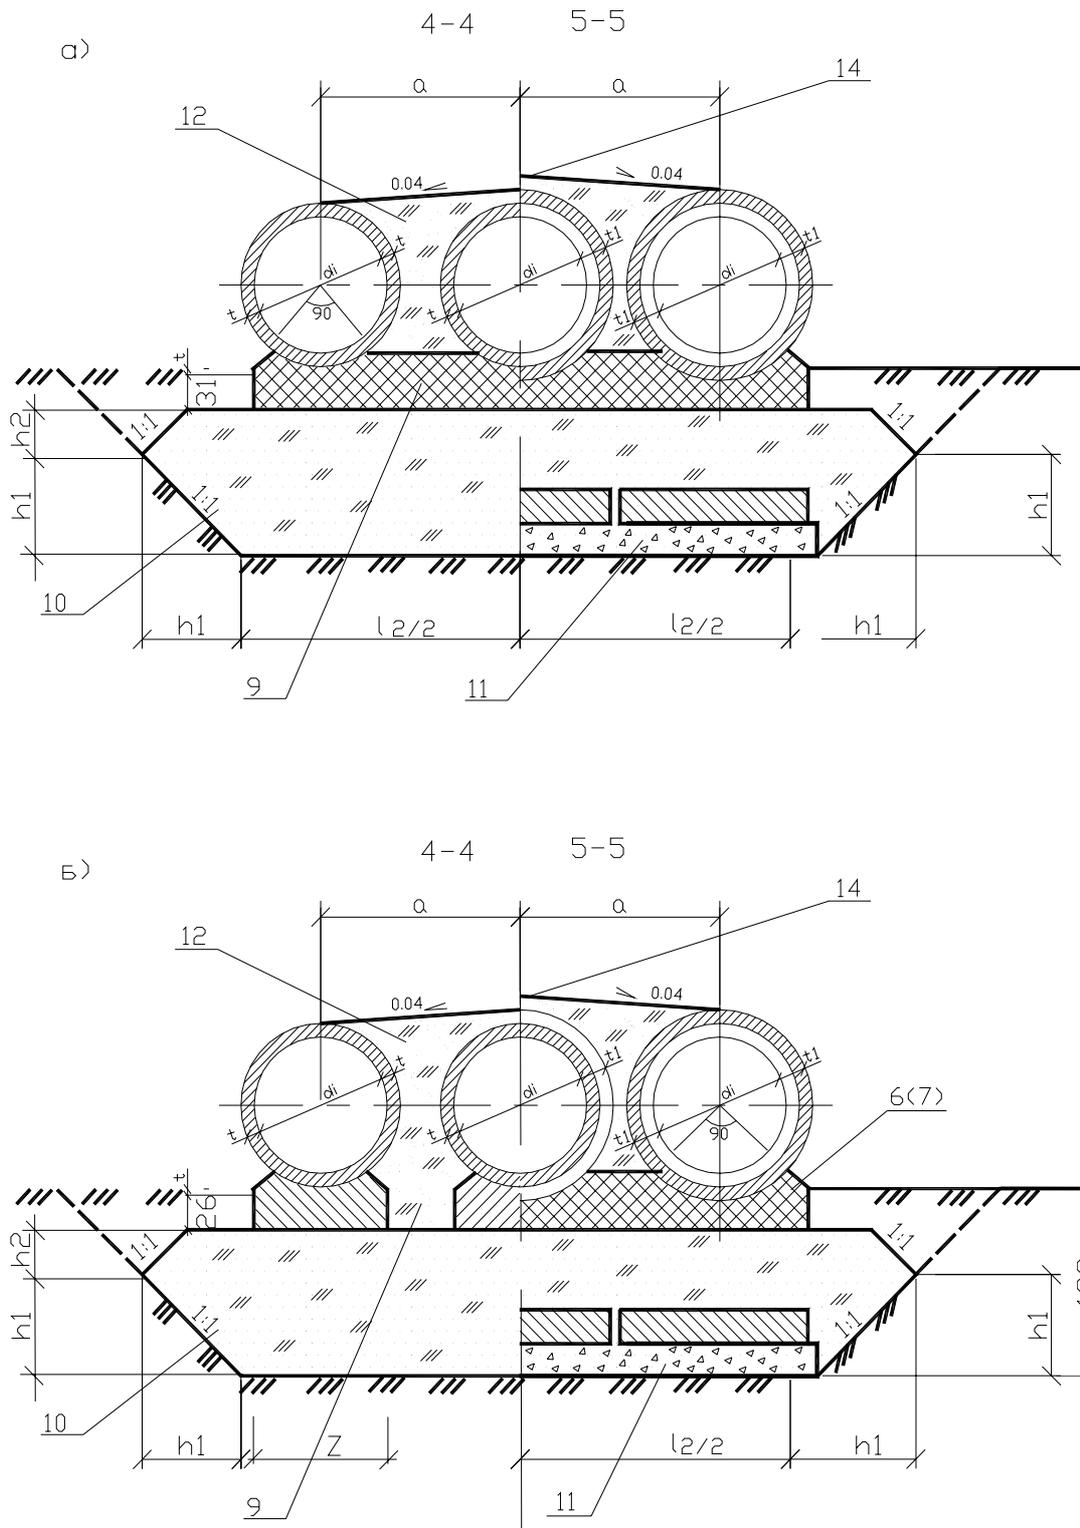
Поперечные сечения 4-4 и 5-5 (см. рис. 8.5) трехочковой трубы на фундаментах: а) монолитном ; б) сборном (4 - блок фундамента: 9 - бетон В20; 11 - подготовка из
